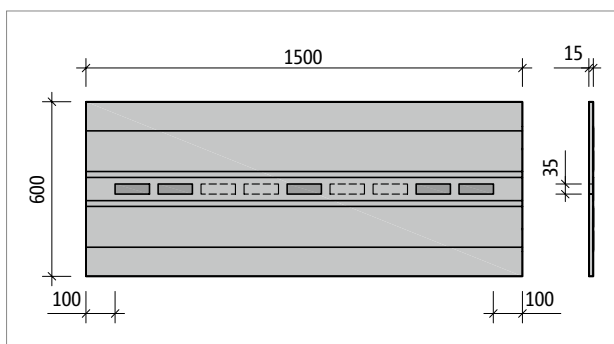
Tronsole® B-V1...-B600: Produktgrundriss
